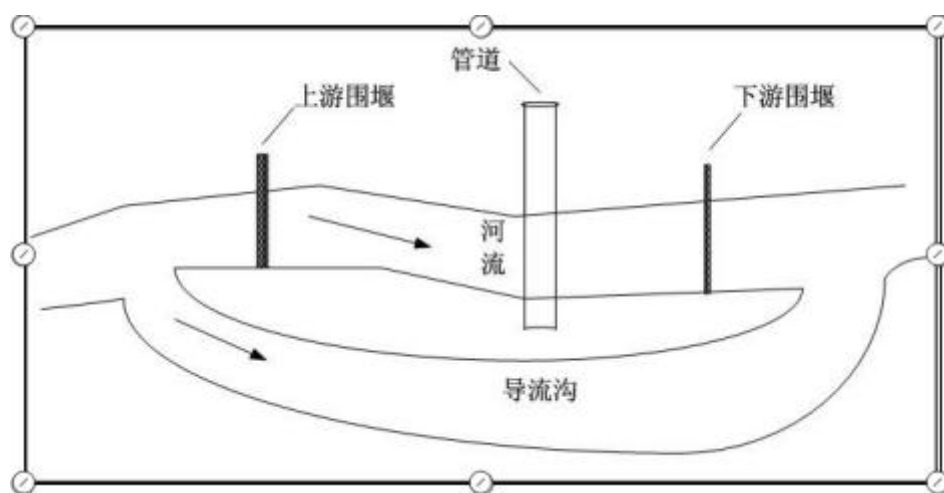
围堰导流开挖管沟法施工断面示意图
